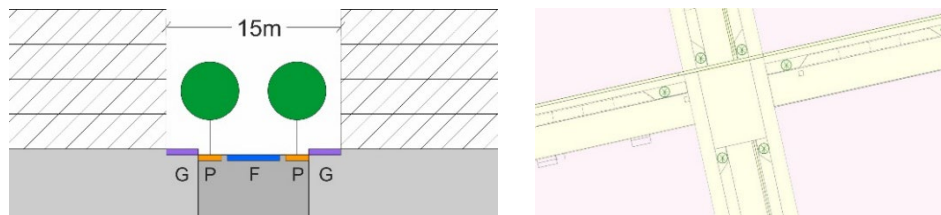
Sammelstraße, Schnitt- / Lageplan, Eigene Darstellung 2020
